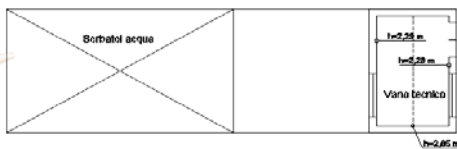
Planimetria stato di fatto con indicazione della sagoma del vano motori e serbatoi.
